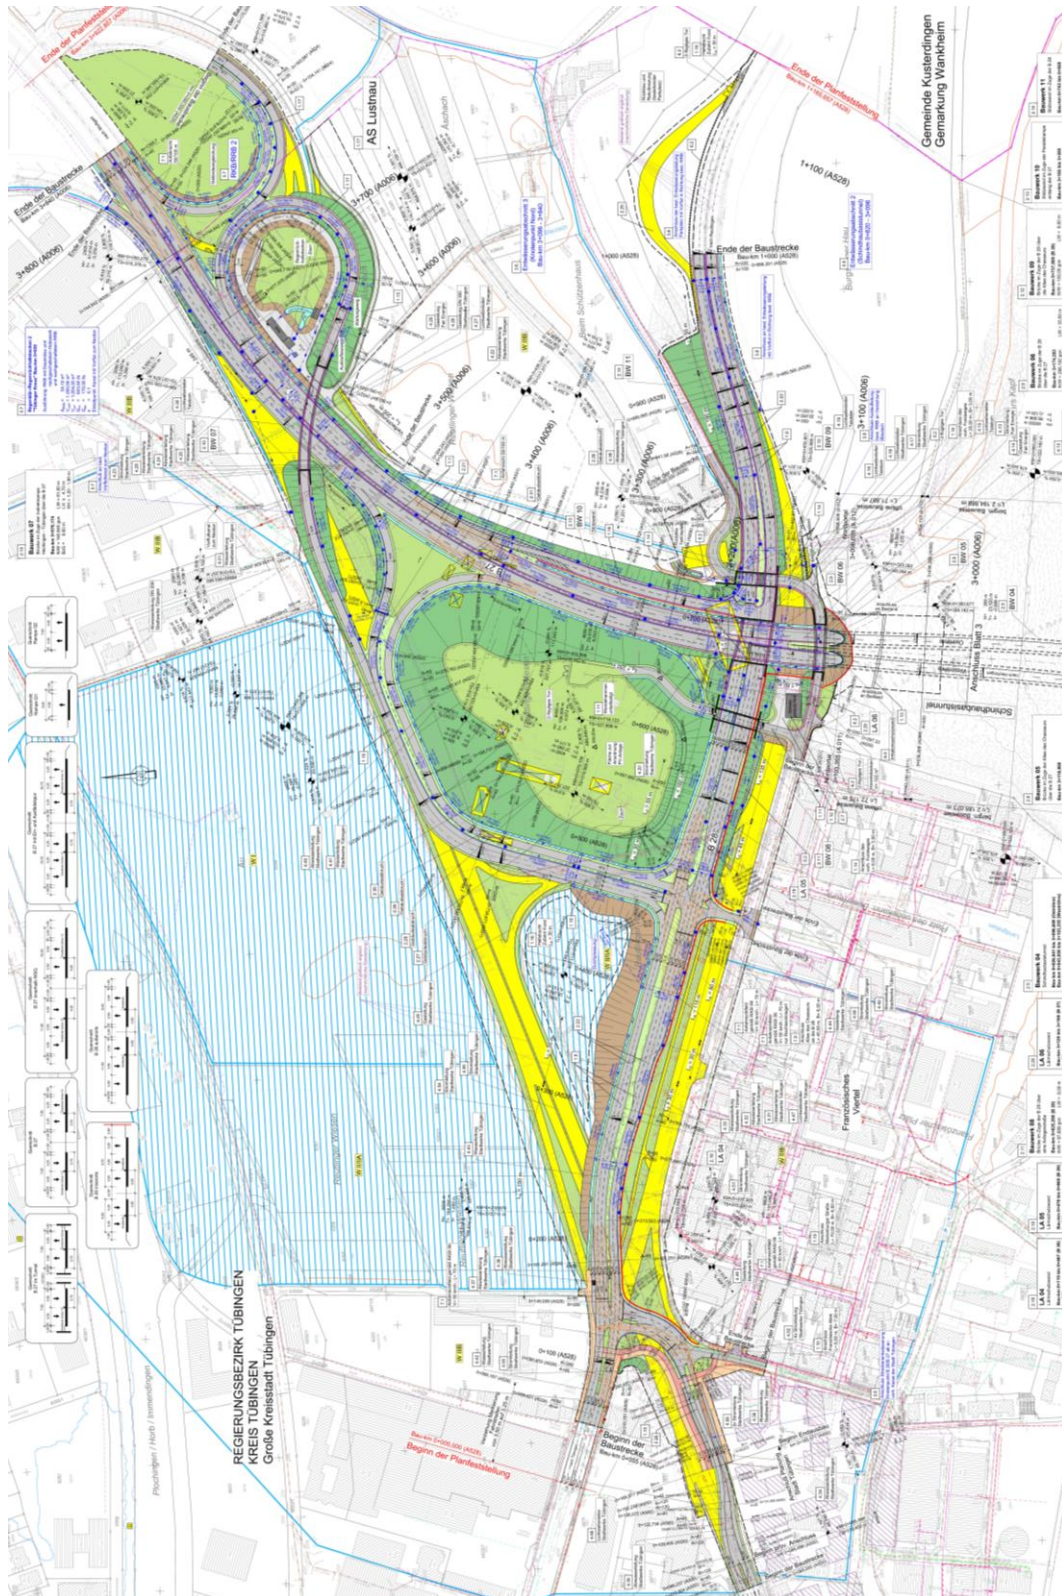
Lageplan der Baumaßnahme: AS Tübingen Nord (Quelle: RPT, 2024).
